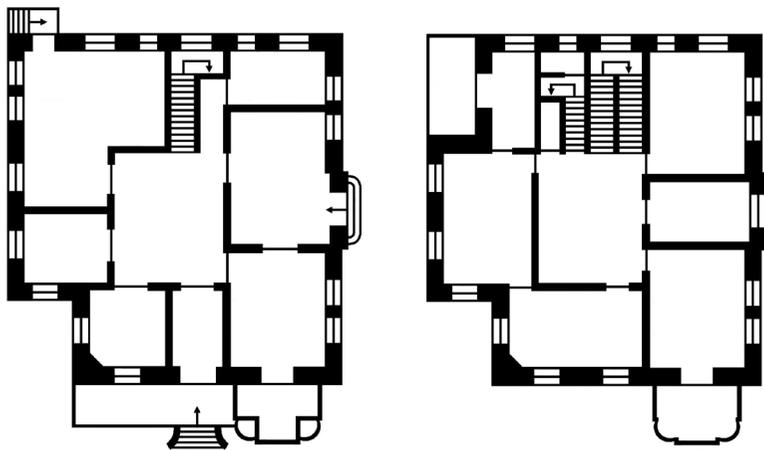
Planimetría orientativa. A la izquierda, planta baja; a la derecha, planta superior. Elaboración propia
